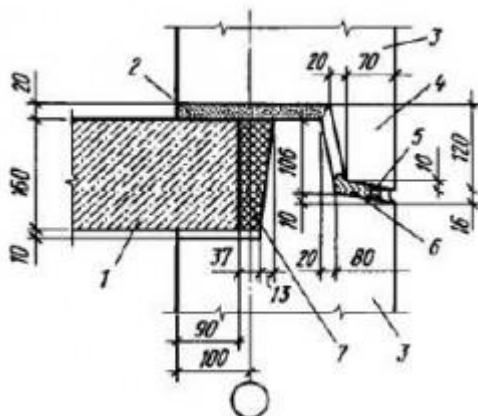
Конструкция горизонтального стыка однослойных стеновых панелей: 1 — железобетонная панель перекрытия, 2 — цементный раствор, 3 — стеновая панель, 4 — противодождевой барьер, 5 — герметизирующая мастика (тиоколовая или полиизобутиленовая УМС-50), 6 — поризол или гернит, 7 — термовкладыш в гидроизоляционной оболочке
